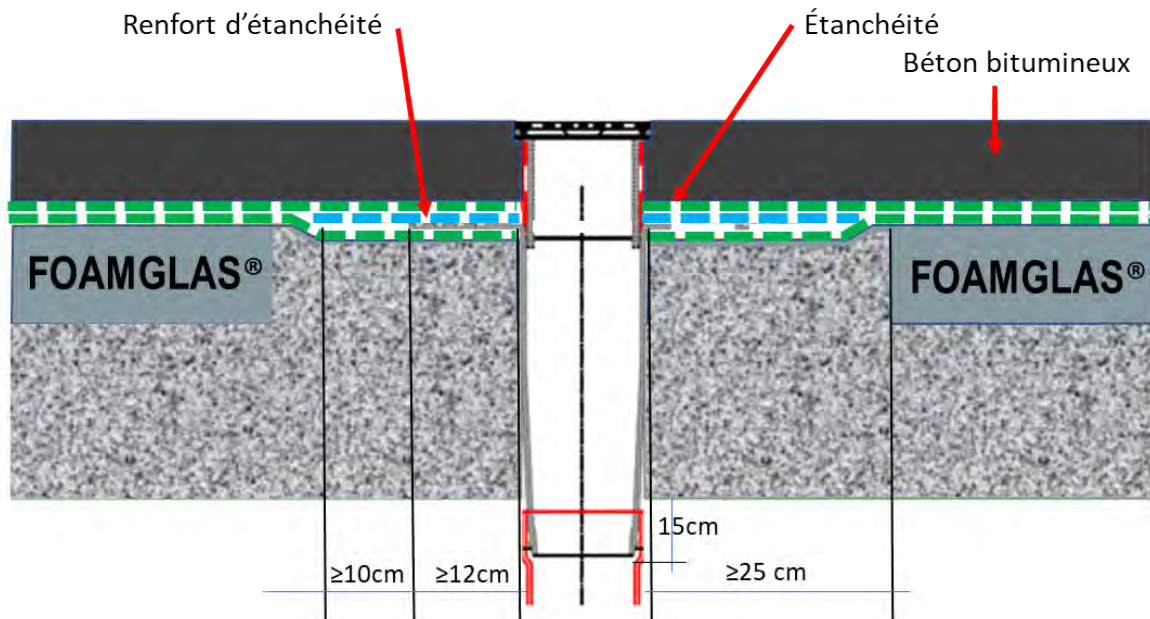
Traitement entrée eau pluviale en terrasse accessible aux véhicules
